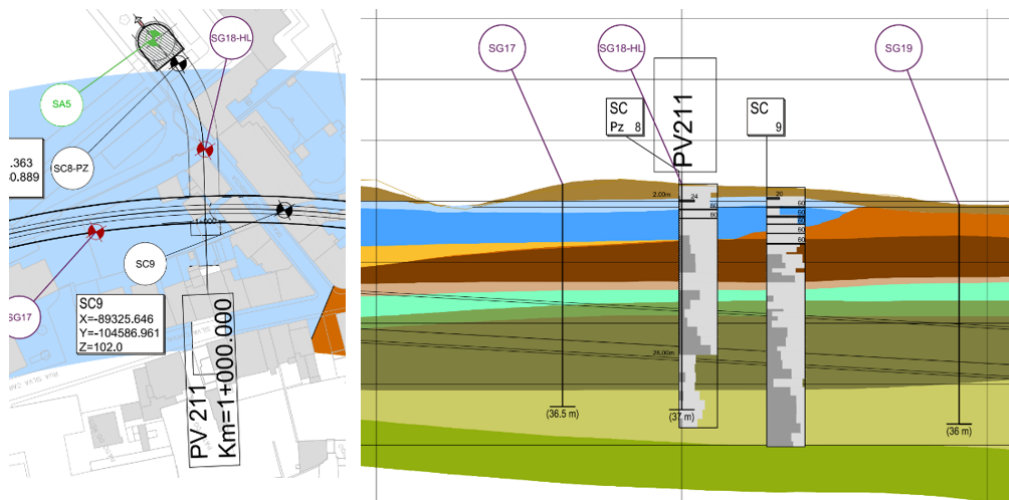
Planta e perfil longitudinal – Geologia / Geotecnia.
